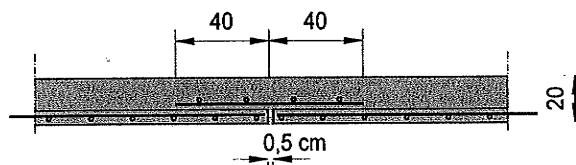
Aciers de couture au droit du joint entre prédalles.
